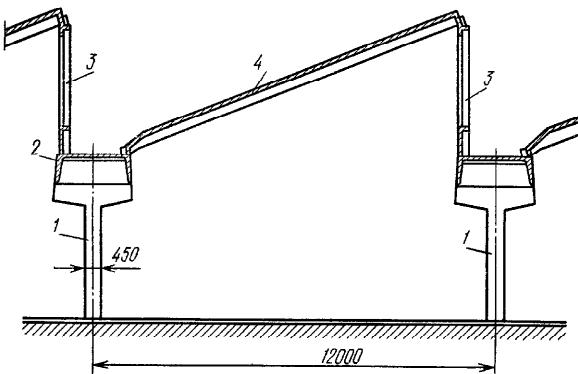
Здание ячейкового типа с шедовым покрытием:
